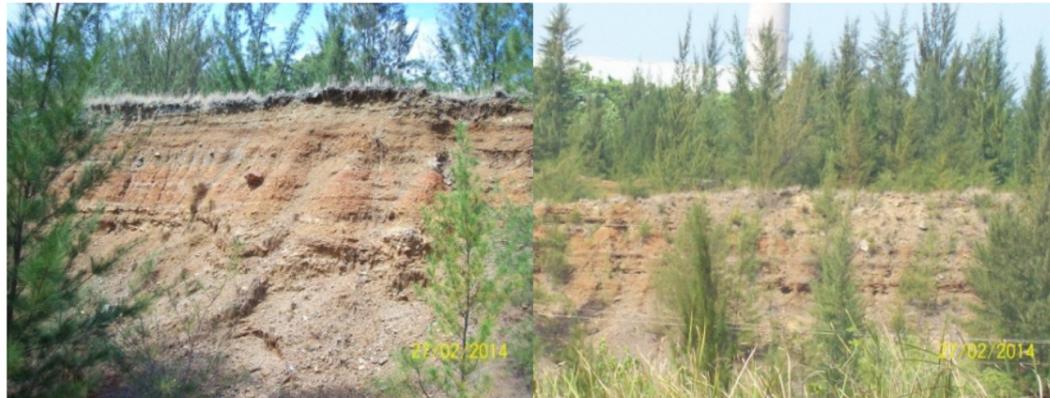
Erosión intensa en taludes de la planta Las Camariocas.
